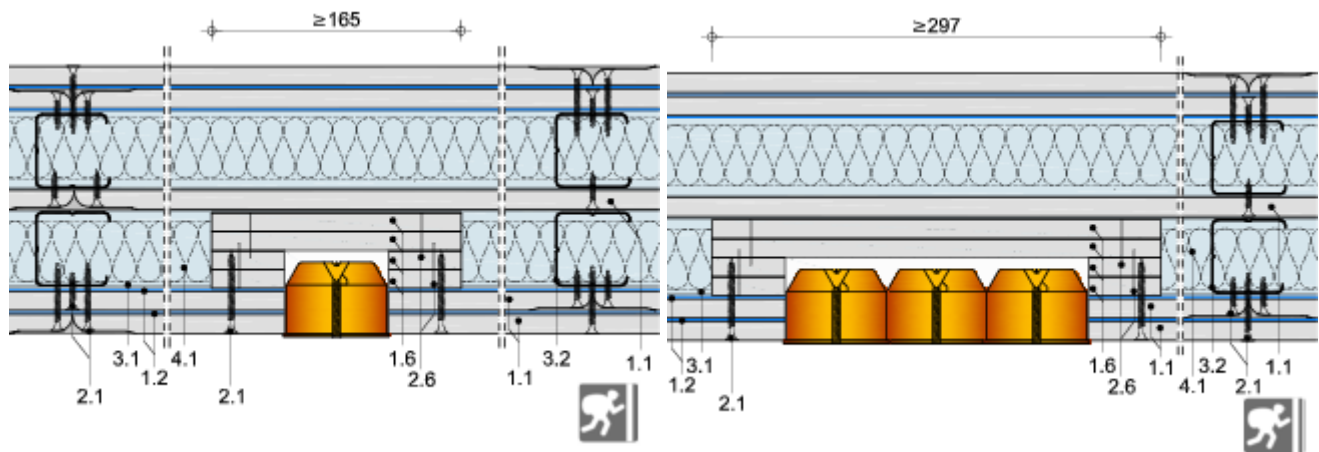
Einbau von Steckdosen Einfachständerwand RC 3
